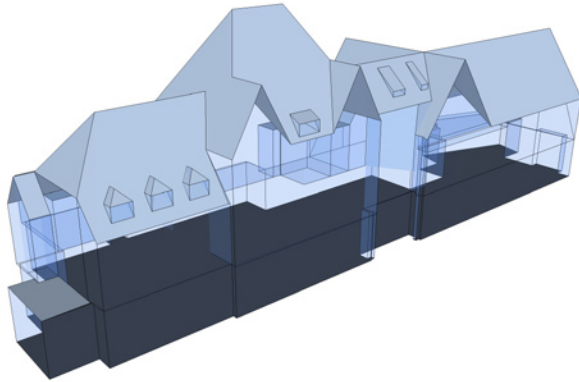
Dachformen aus Luftbildauswertung, Grundriss und berechnete Seitenflächen am Beispiel der Alten Feuerwache Überseestadt Bremen
